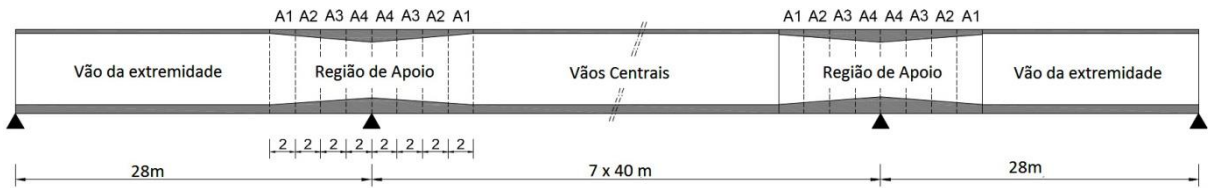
Discretização das vigas metálicas utilizadas na modelagem numérica (adaptado de Figueiredo, 2007)
